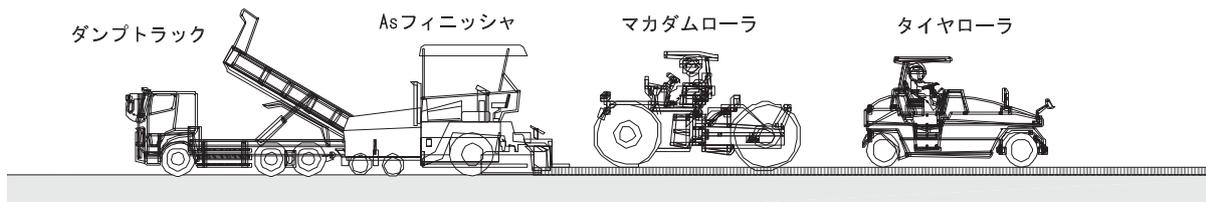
半たわみ性舗装（表層）の施工状況
